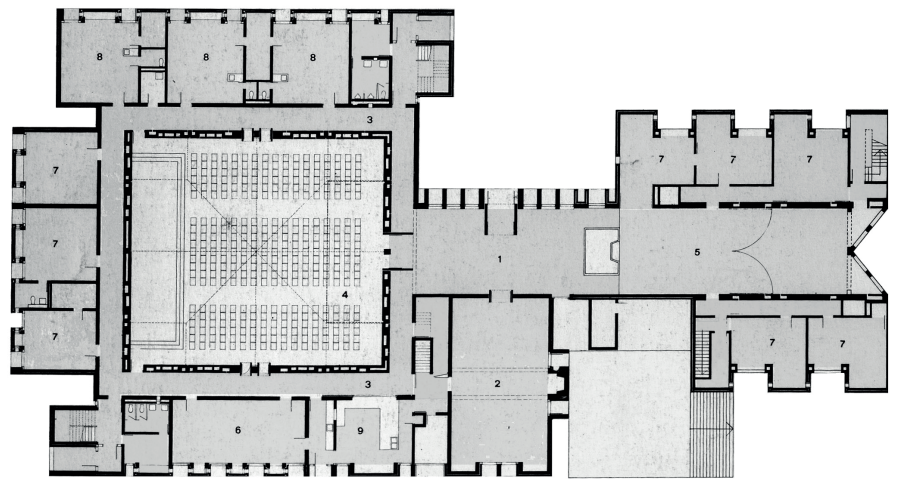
Planta da segunda proposta para a First Unitarian Church.
